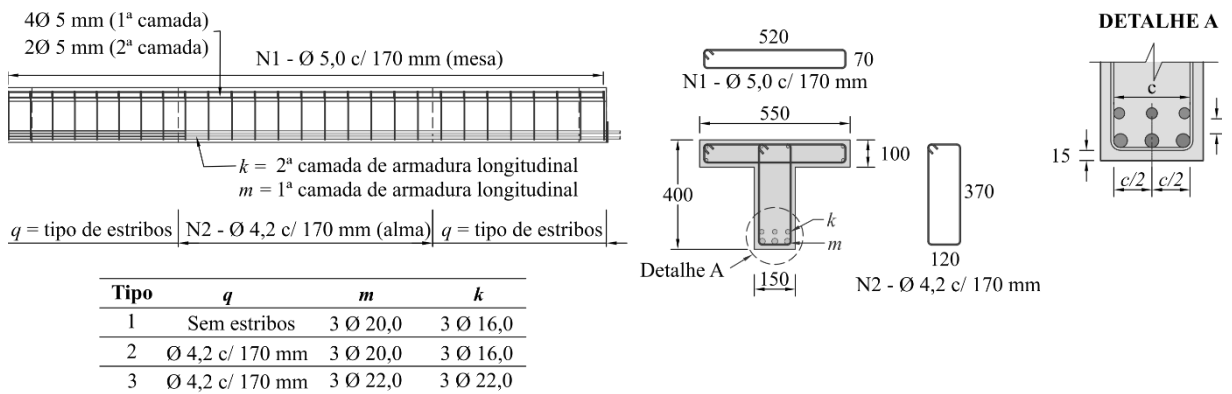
Detalhamento das armaduras internas de aço (dimensões em mm).
